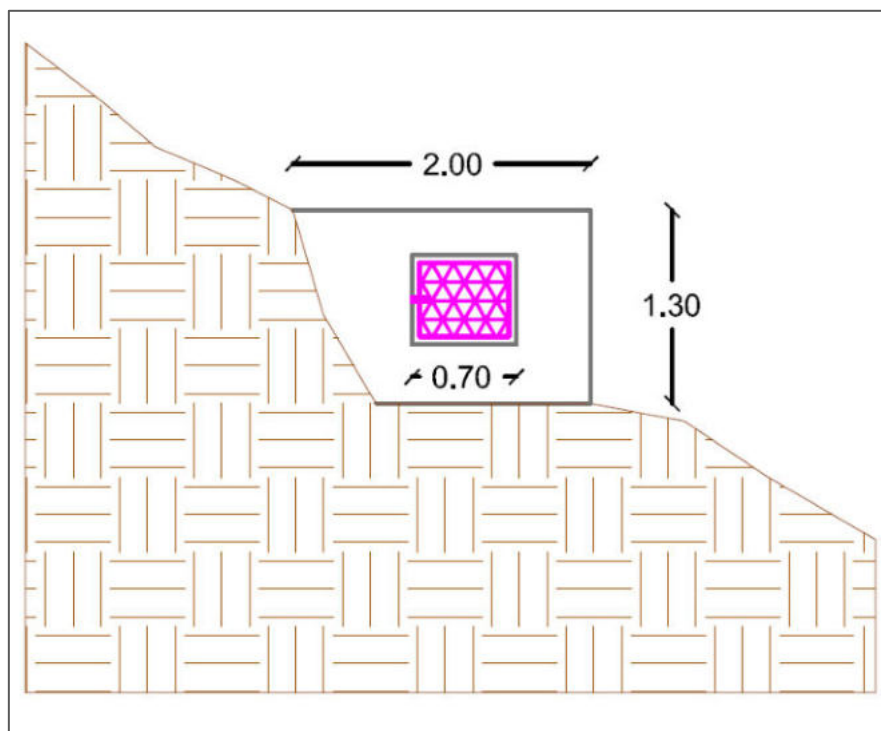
Prospetto frontale Sorgente 1 Le Pierine
